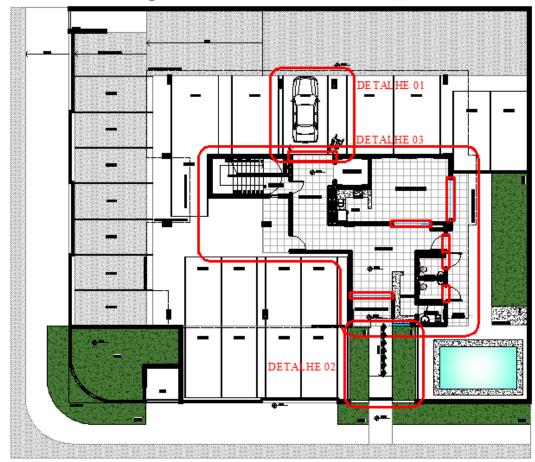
Planta Baixa - Pavimento térreo (1)
